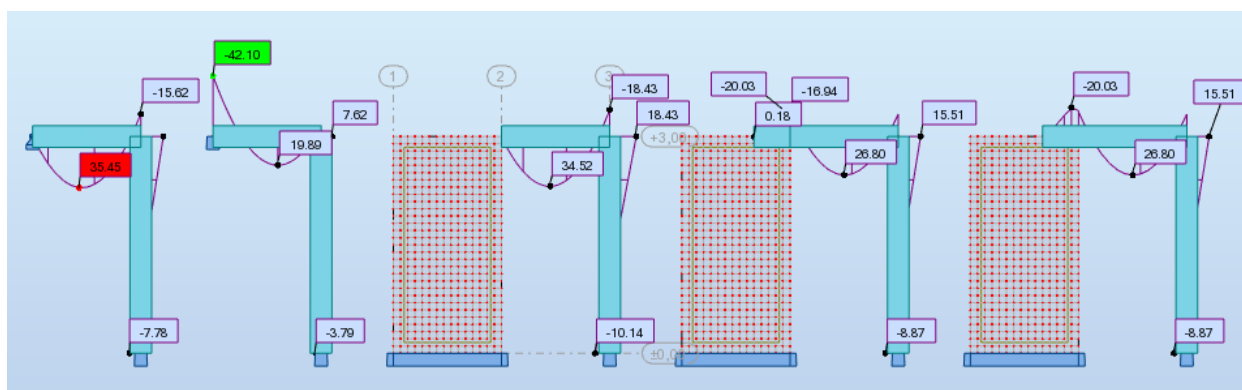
Exemplos de ligação entre uma viga e uma parede
